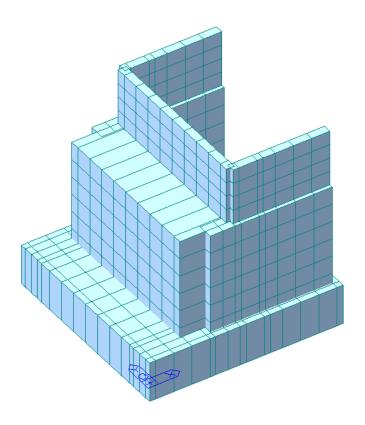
Vista 3D estrusa del modello di calcolo Spalle
